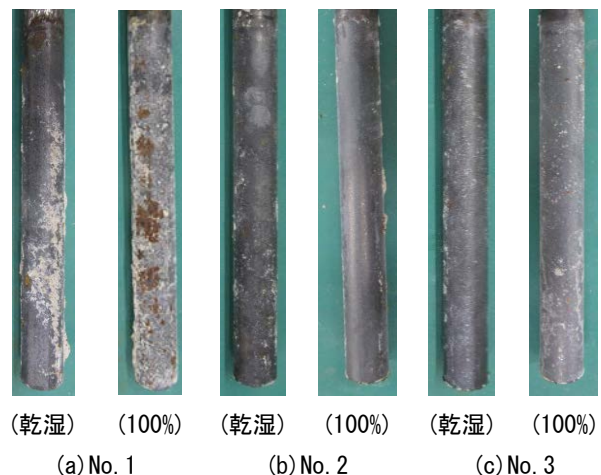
自然電位が卑化した直後の鉄筋腐食状況
